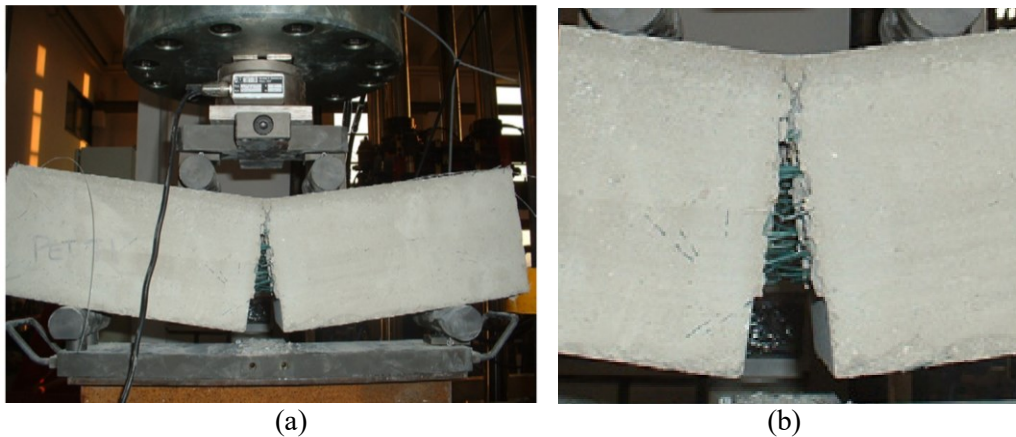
(a) Configuración de colapso de una viga con fibras PET en ensayo de flexión. (b) Detalle del efecto de puente de las fibras sobre la grieta [30].
